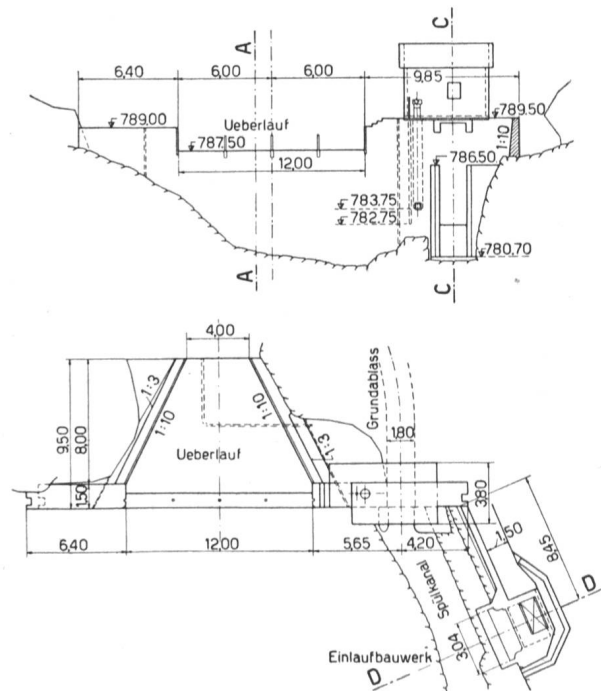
Staumauer und Einlaufbauwerk, 1:500.
